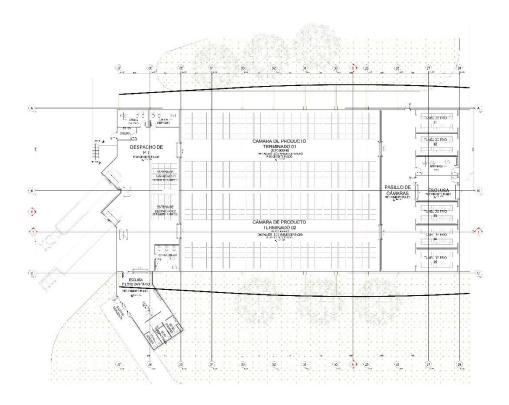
Plano arquitectónico de sector 2 – Primer Nivel. Fuente: Propia [Elaborado 10.12.2018]
